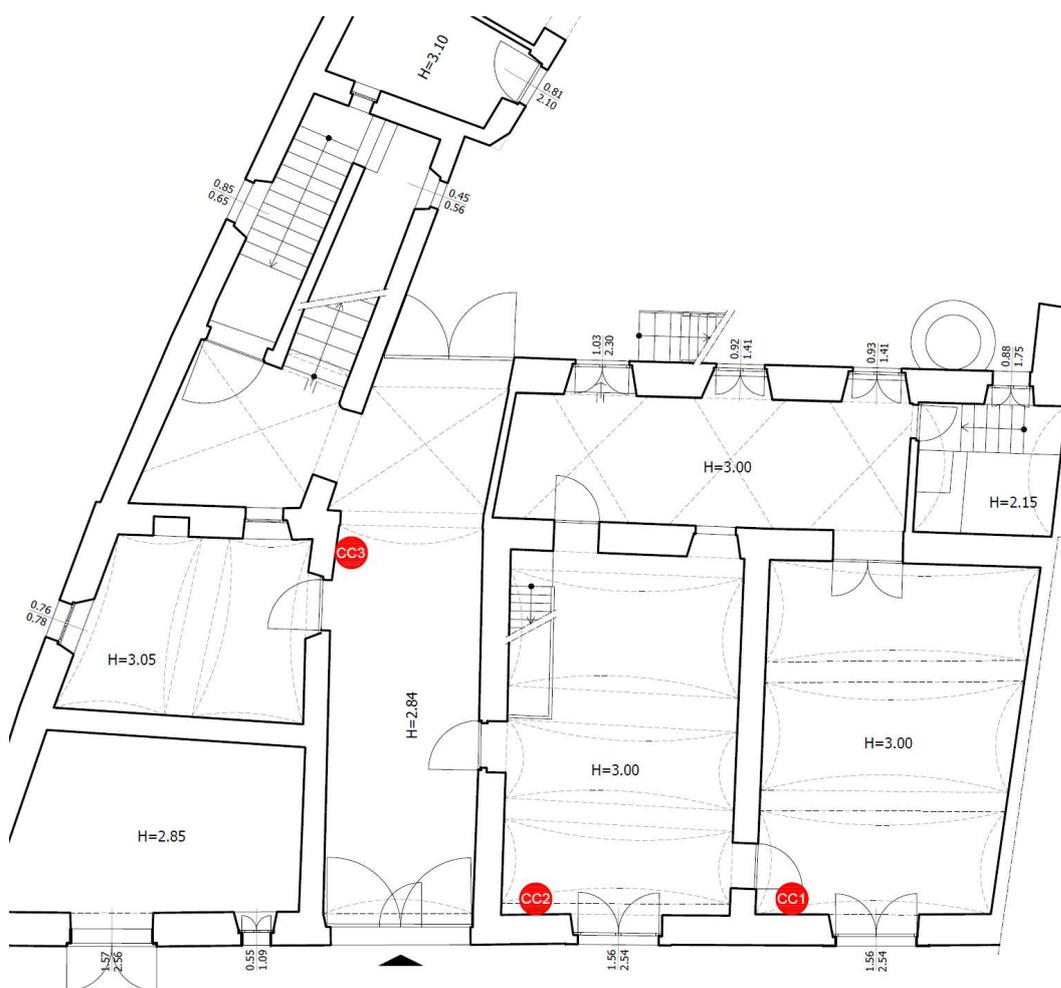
Stralcio della pianta del piano terra: ubicazione delle prove al carburo di calcio
